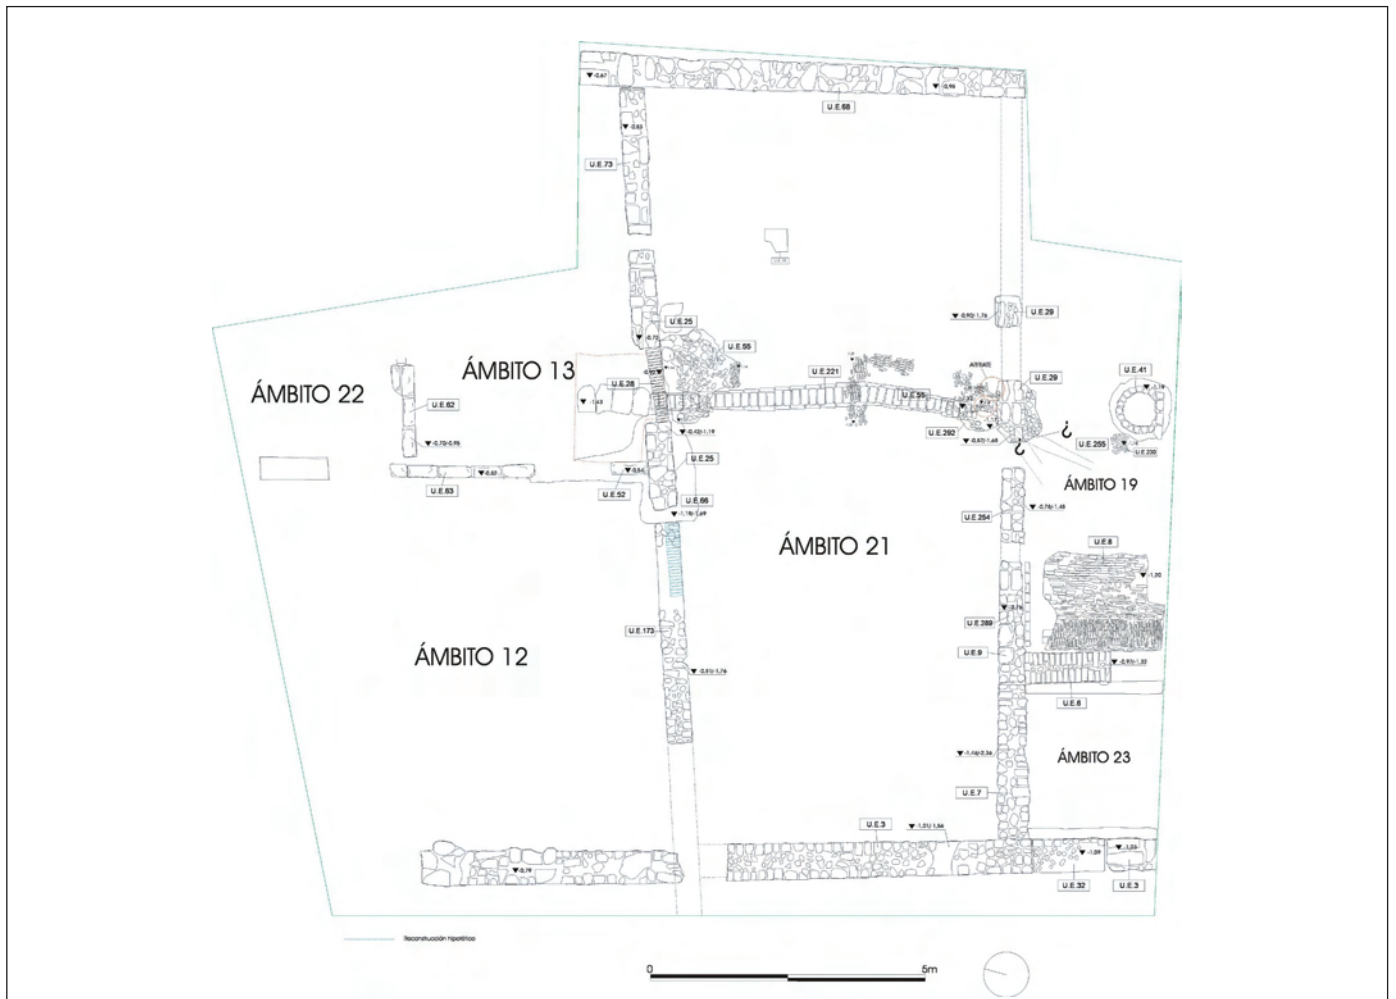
Plano general de la vivienda a finales del siglo XVIII. Fase IV.
